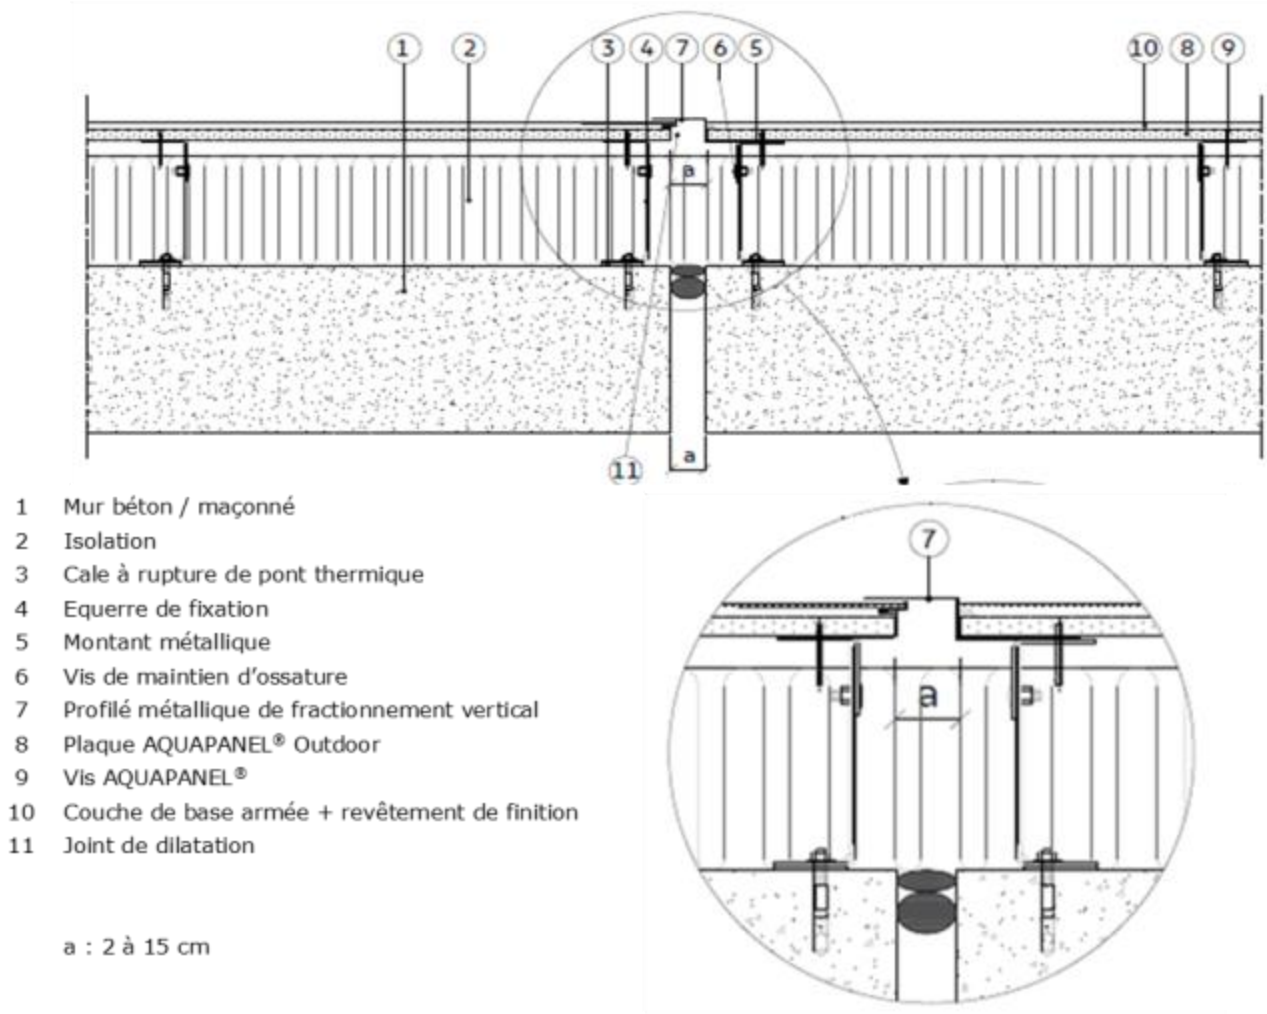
Traitement du joint de dilatation – Coupe horizontale sur ossature métallique
